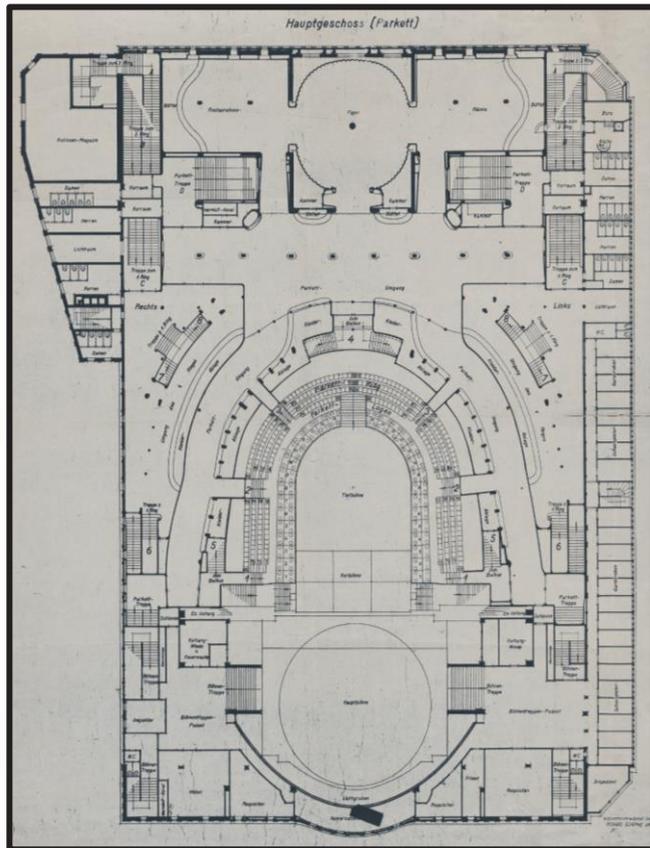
Planta baixa da Grande Casa de Espetáculo de Berlim.
